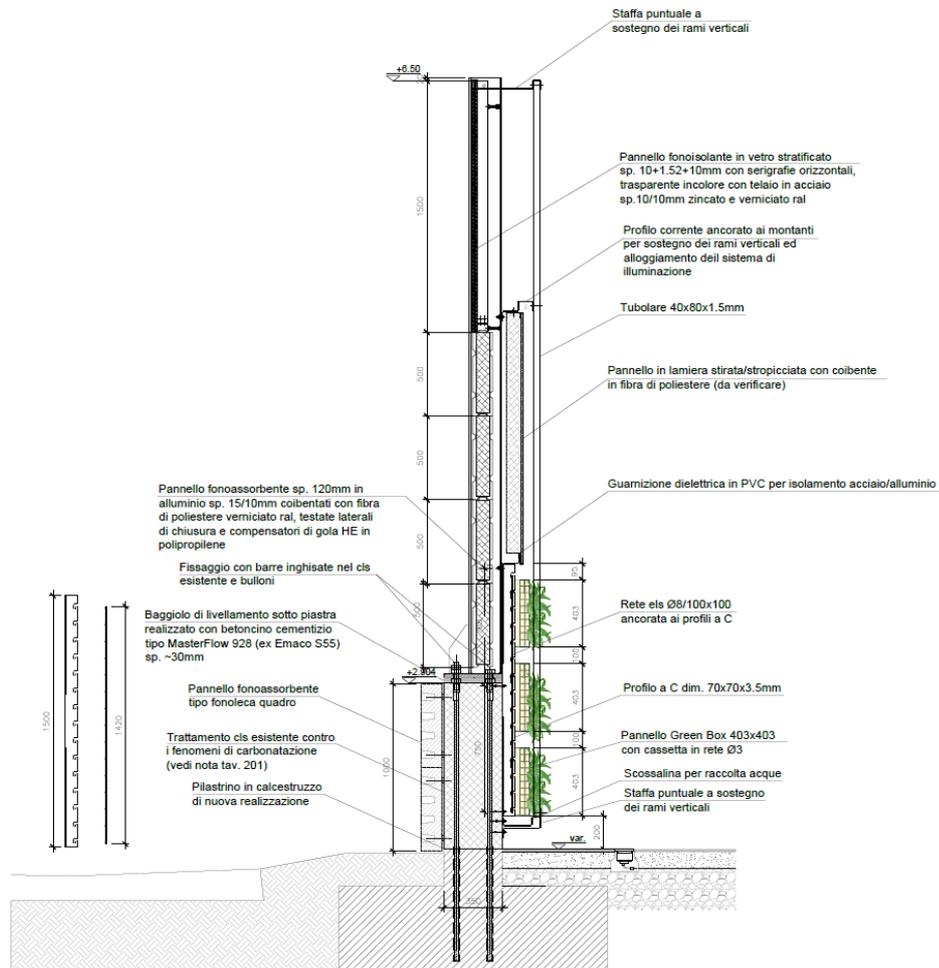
Progetto esecutivo - Protezione antifonica H=4,50 m, sezione tipo (A) – mista.
